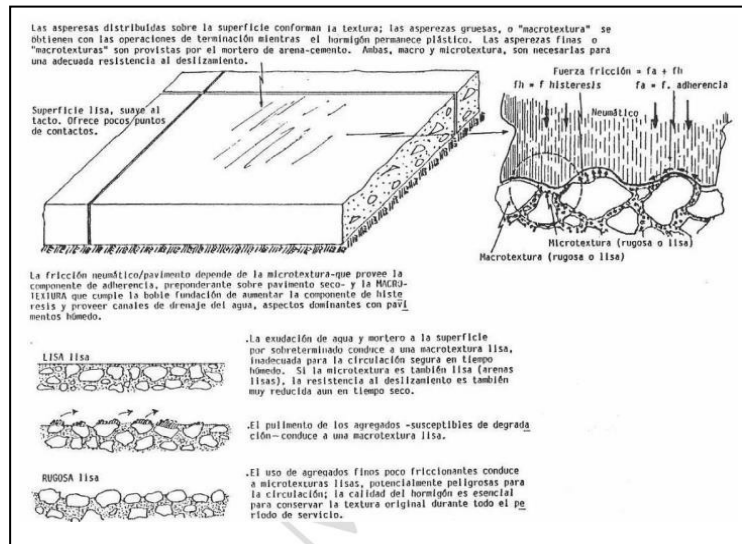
Falla por pulimento superficial de Pavimento Rígido
